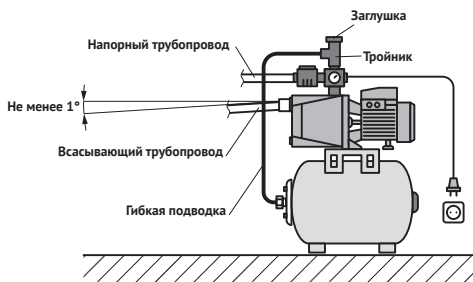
Схема монтажа универсальной насосной станции АКВАРОБОТ JSW 55
